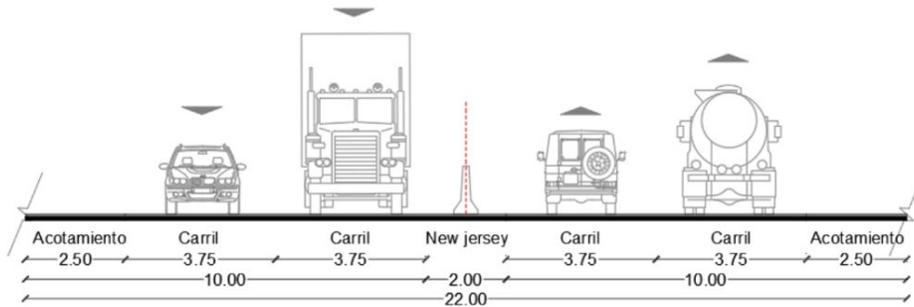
Distribución metros carretera Guadalajara -Ocotlán/ Sección C-C'
